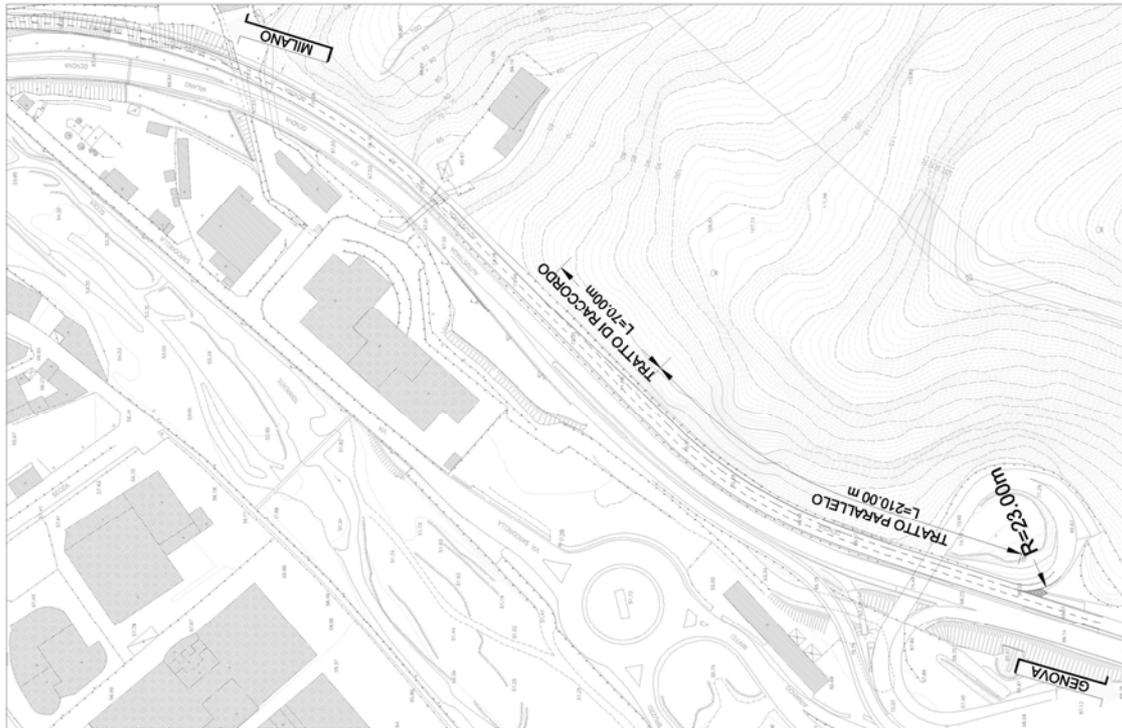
Schema Situazione Attuale immissione svincolo di Bolzaneto
